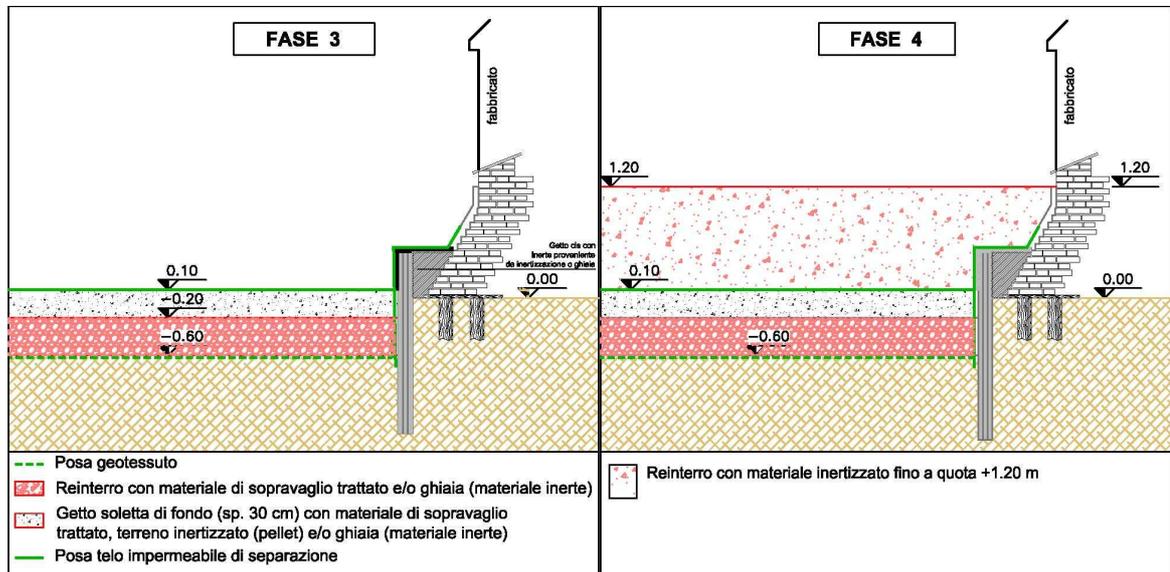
Fasi di intervento primo lotto (pilota)
